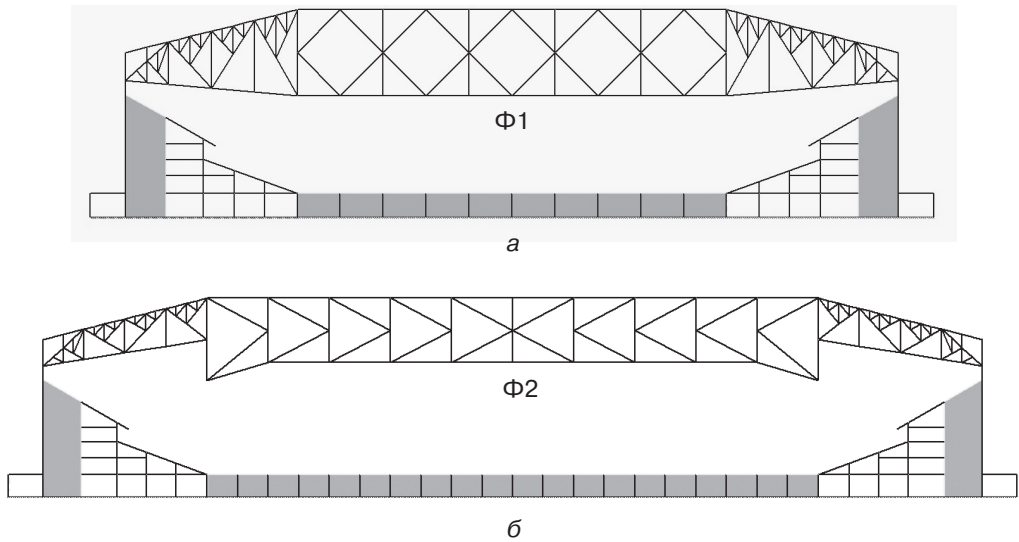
Поперечный (а) и продольный (б) разрезы футбольного стадиона
